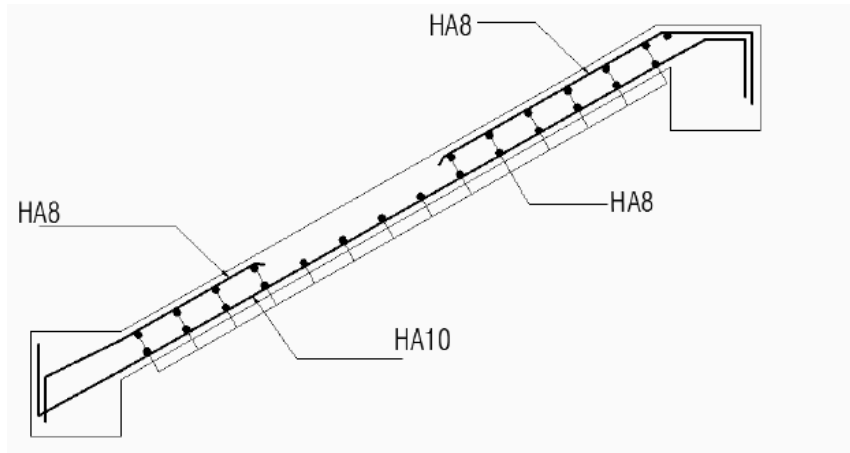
Schéma de ferrailage de l'escalier type 3 (2ème volée)
